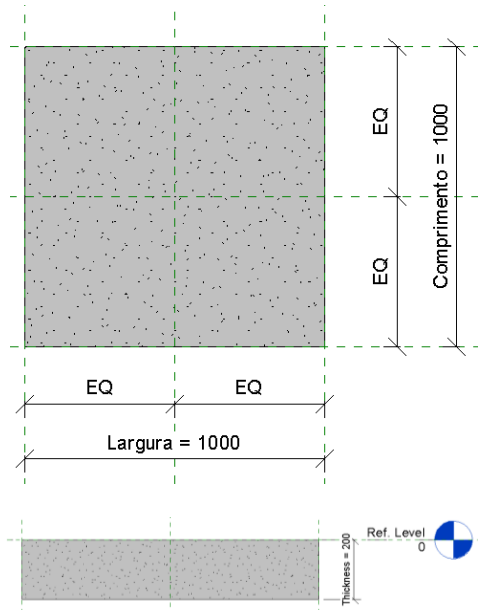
Planta e alçado da família das sapatas no Revit.
